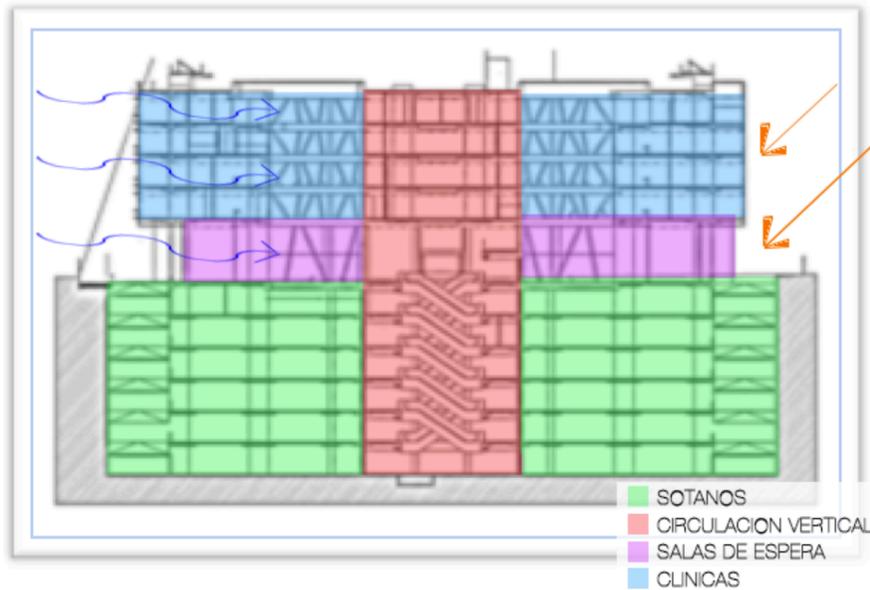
Sección estructural, detalle de sótanos y niveles 1-6.
